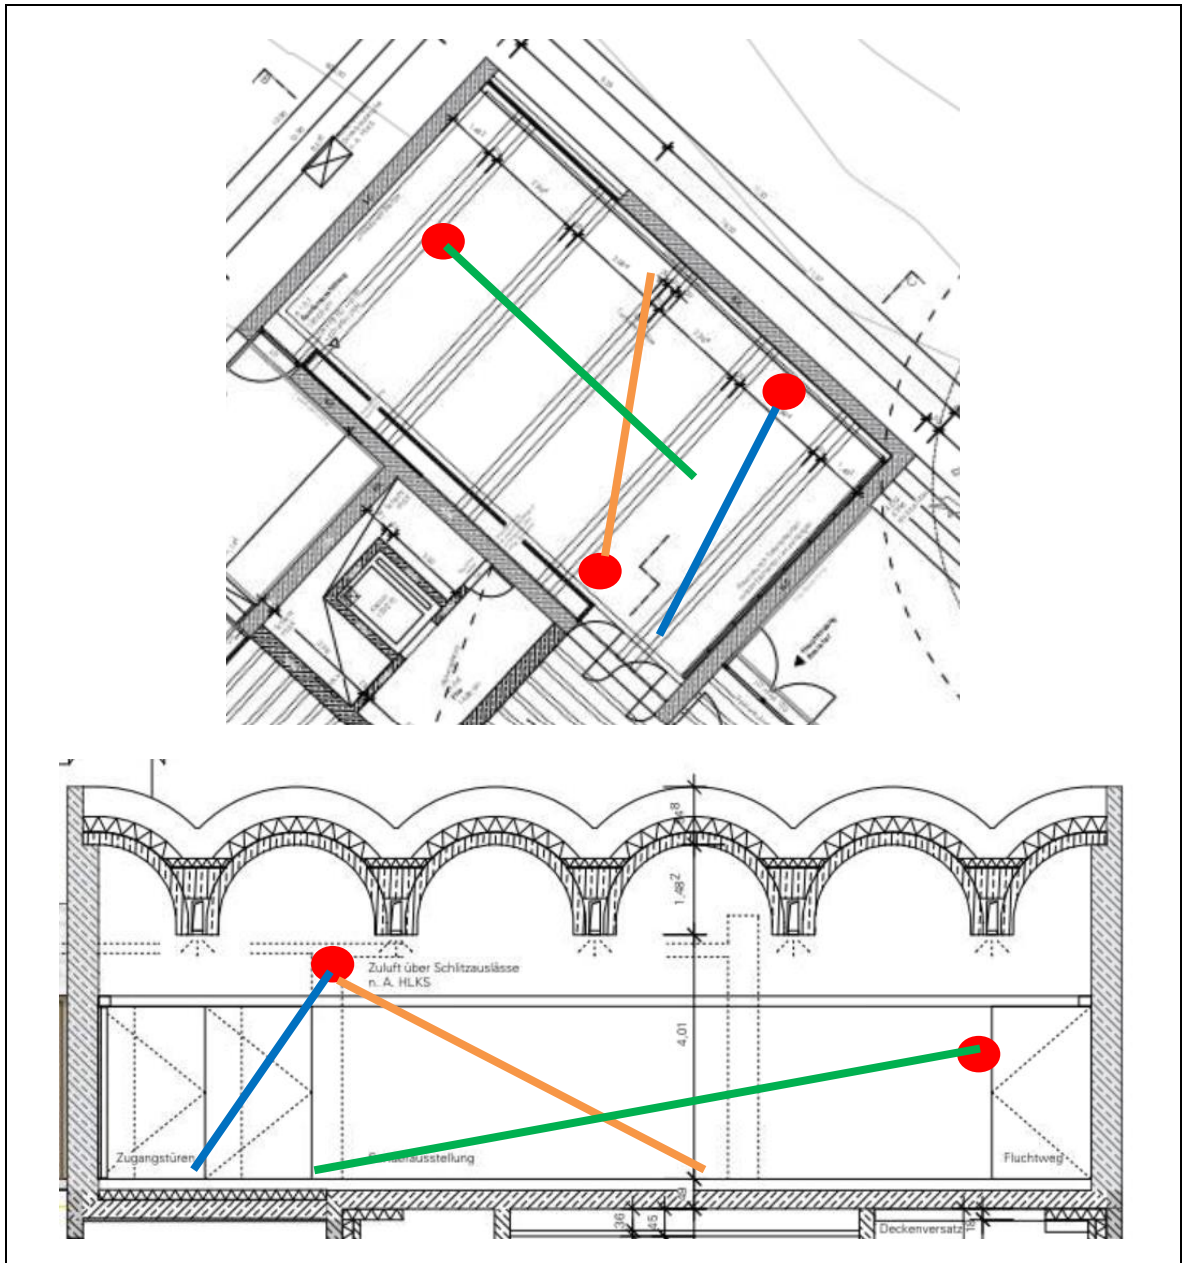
Skizze Lautsprecherausrichtung, eingetragen in Grundriss und Schnitt Meck Architekten [27]
